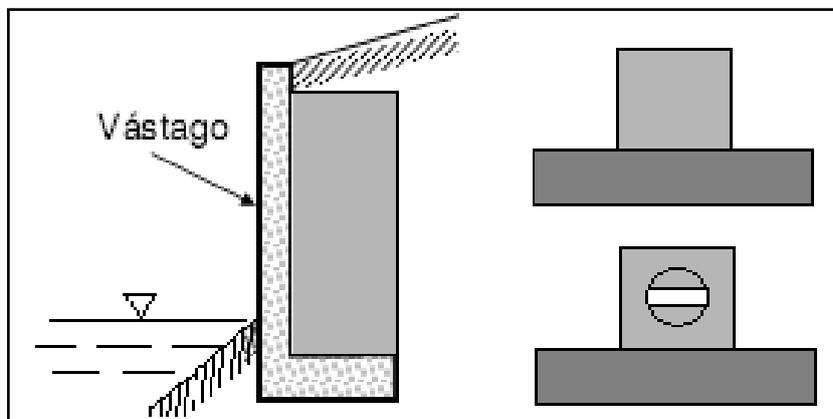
Vista en elevación y planta del estribo tipo “T”
